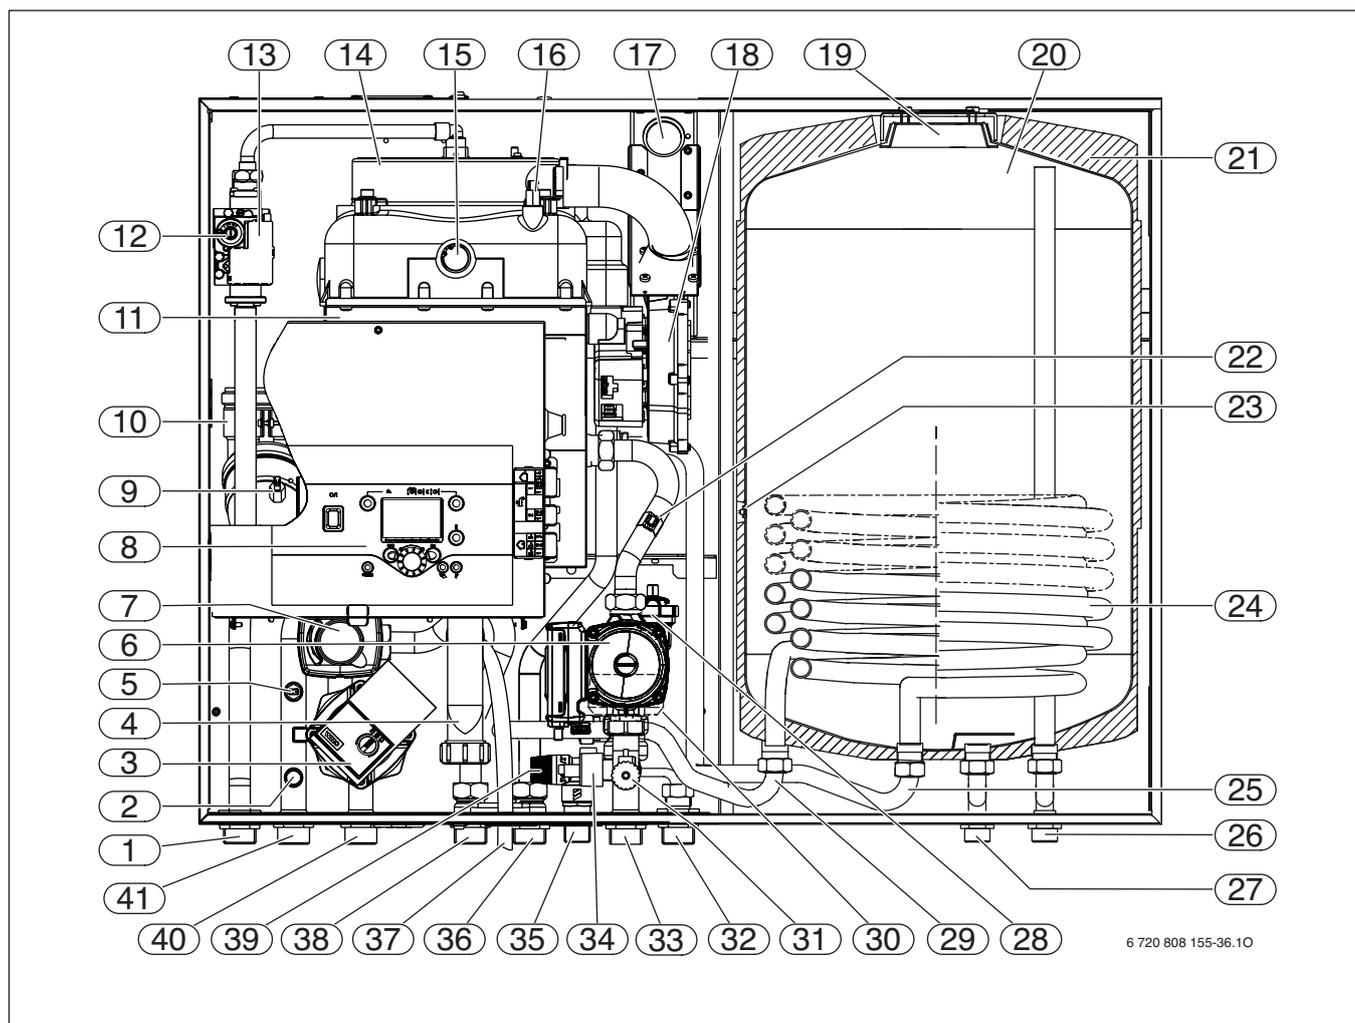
Layout caldaie THR 2-17 M75 HDC
